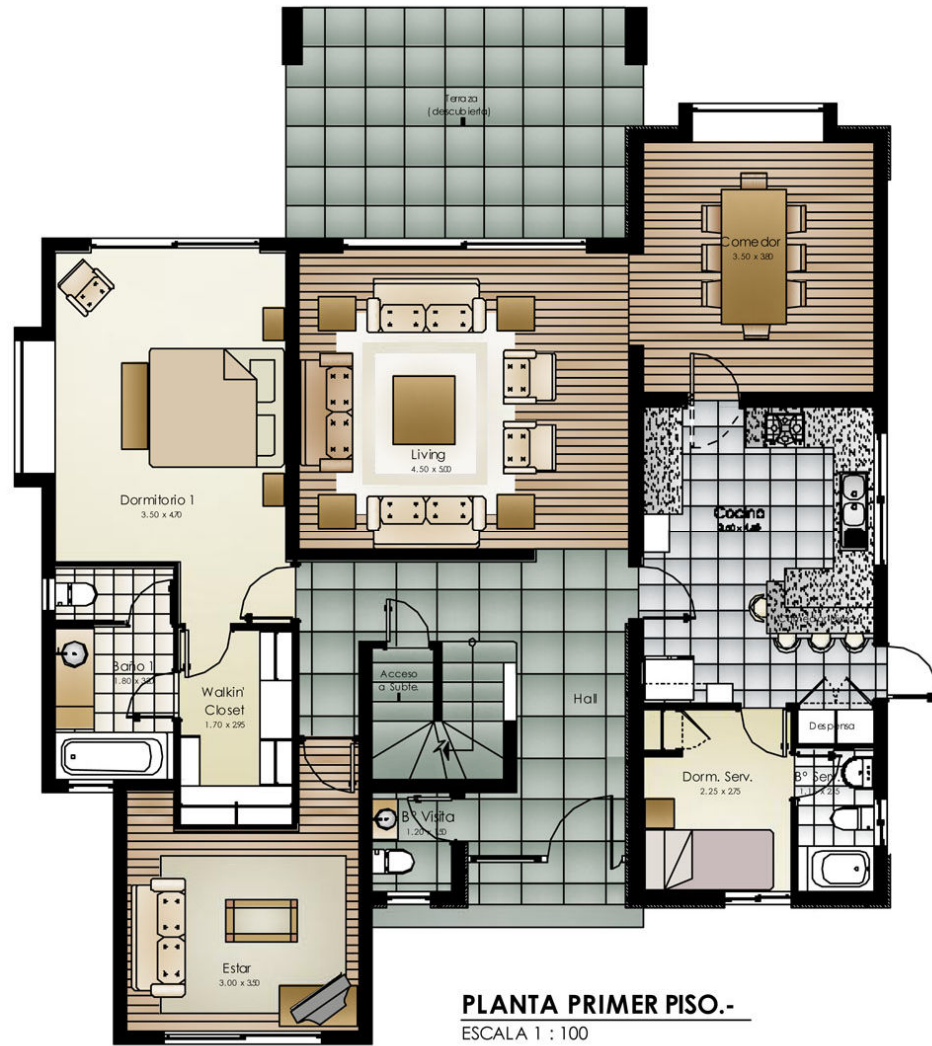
Planta 1^{er} piso⁽³⁾.
